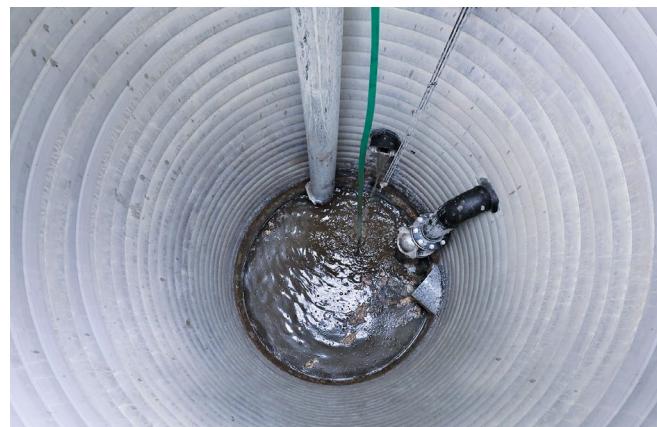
Die Pumpstation Spascher Sand mit dem Sammelschacht nach Sanierung
